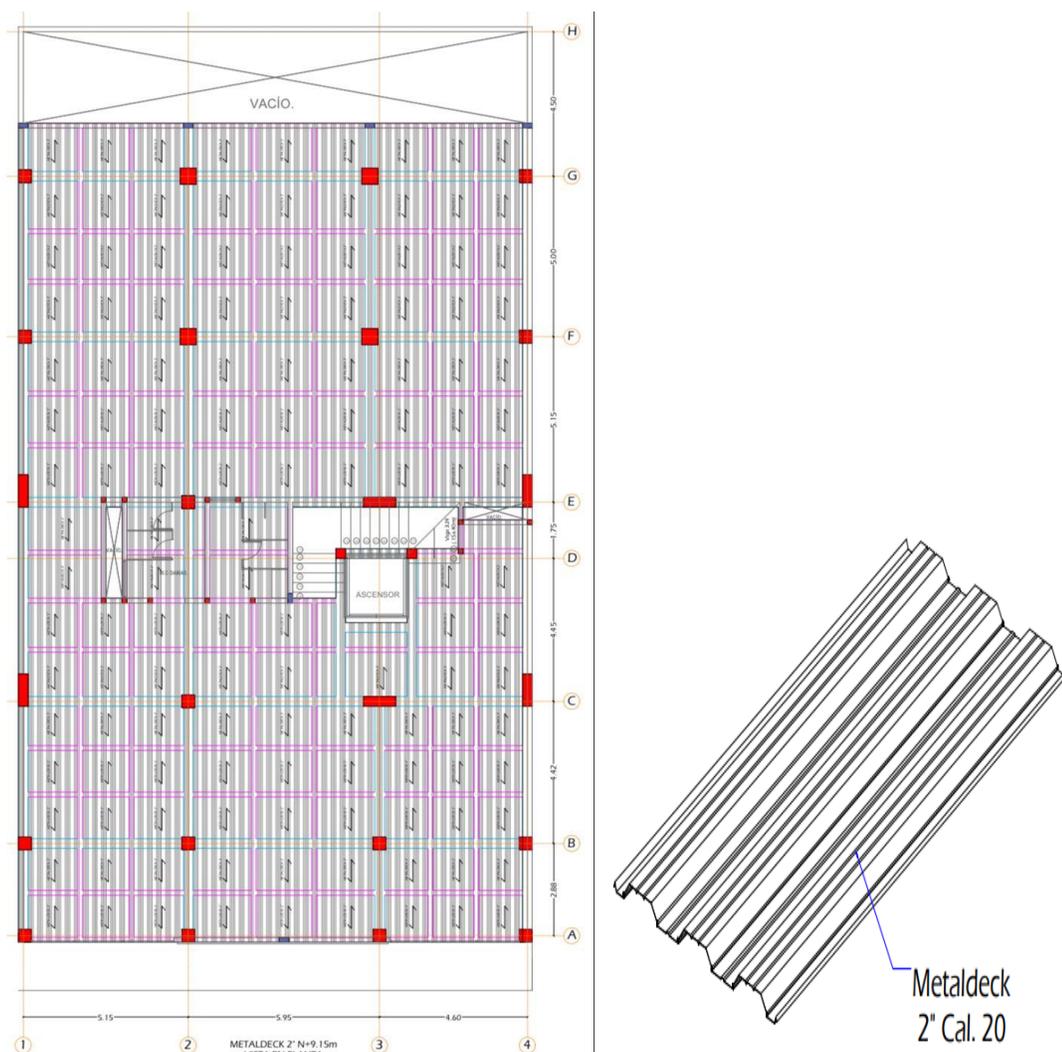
Metaldeck 2" vista en planta Edificio Wiedii
